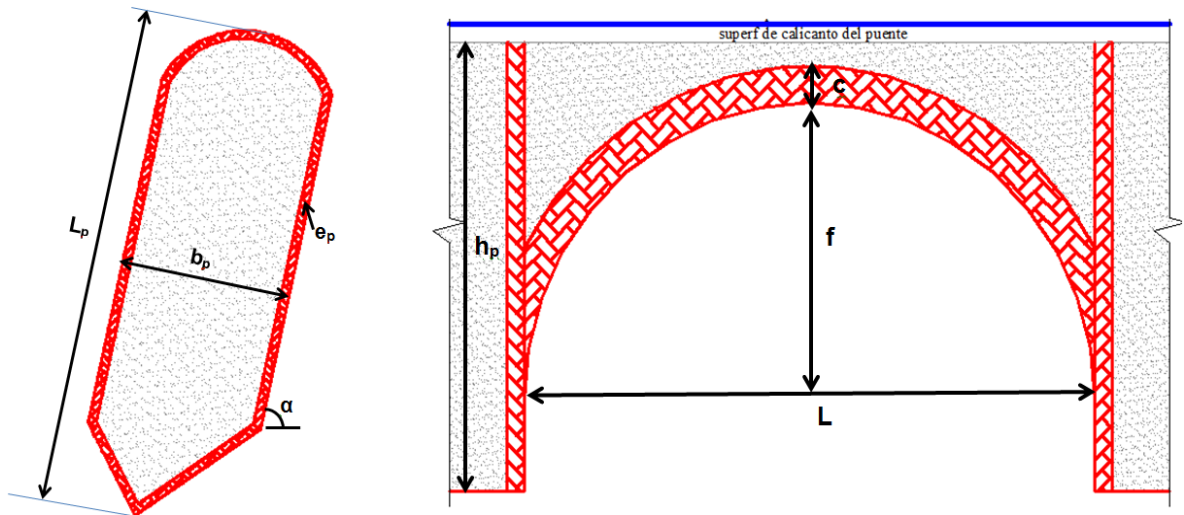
Geometría del Pilar en planta y del arco en elevación.
